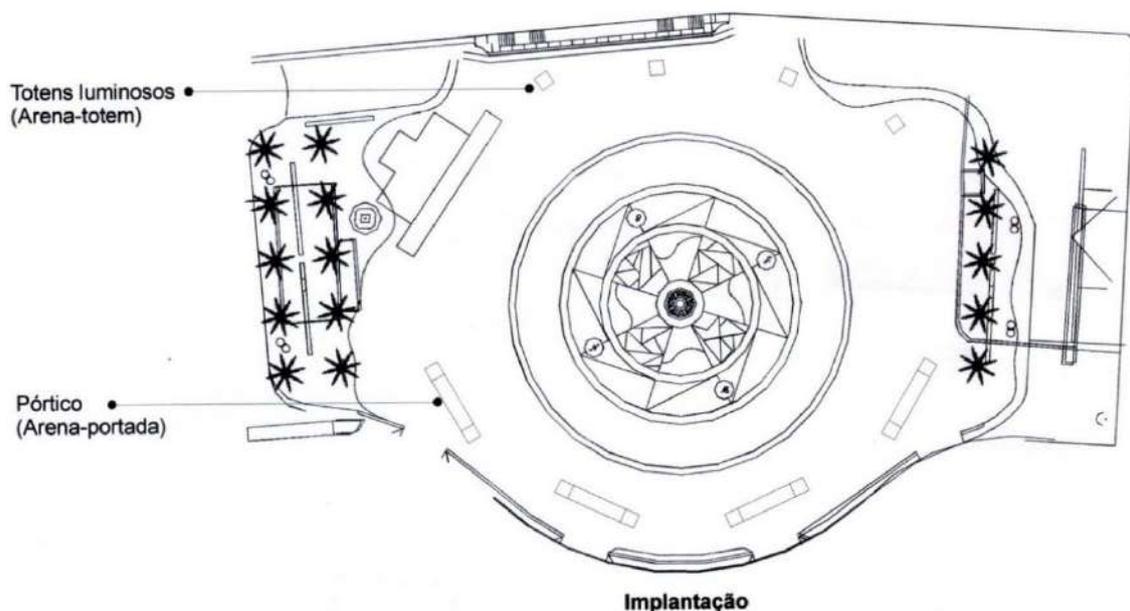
Planta baixa da Arena Polo Multicultural, sem escala.
